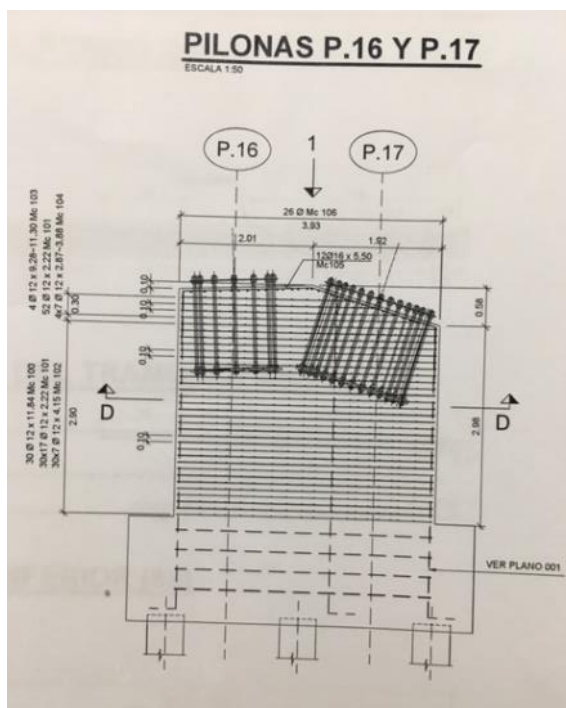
Armado de acero de pedestal de la piona P.16-17
